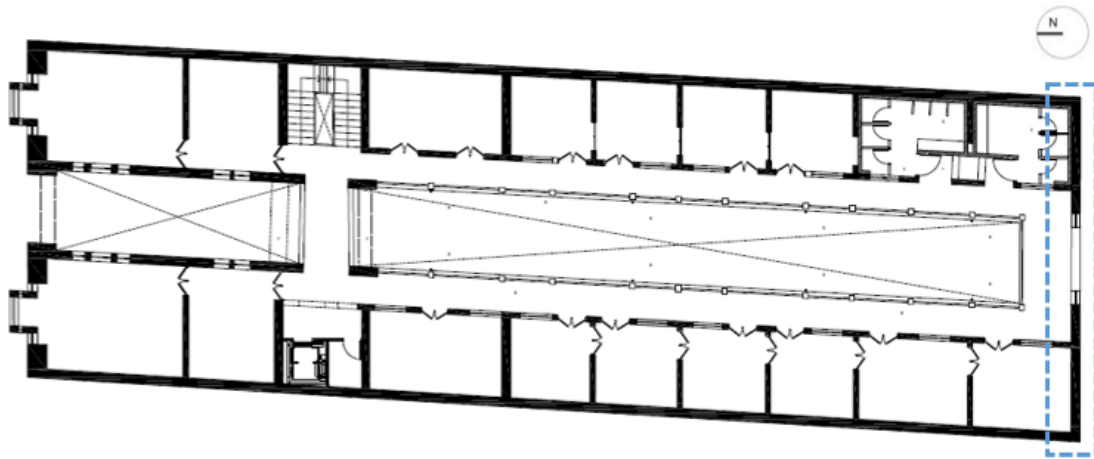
Plano del Pasaje León, planta alta, en donde se señala el muro intervenido.
